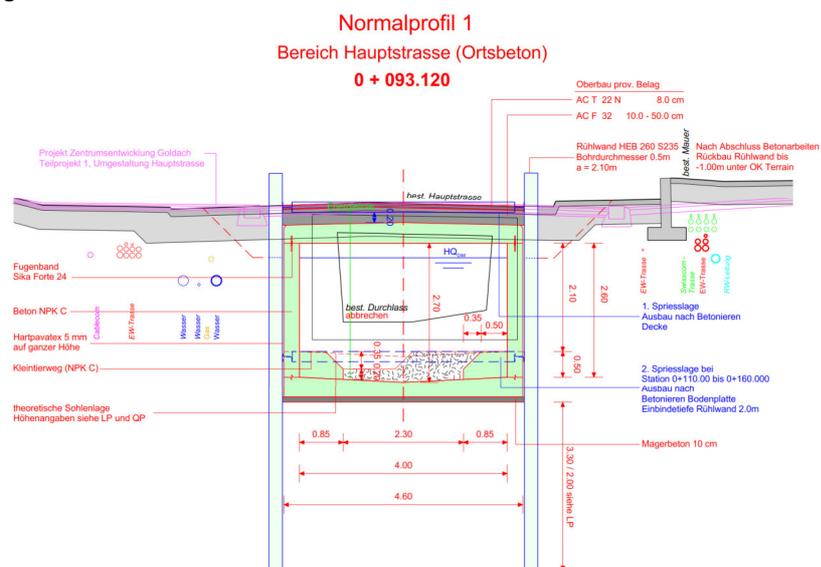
Normalprofil 1, Bereich Hauptstrasse (Ortbeton)
